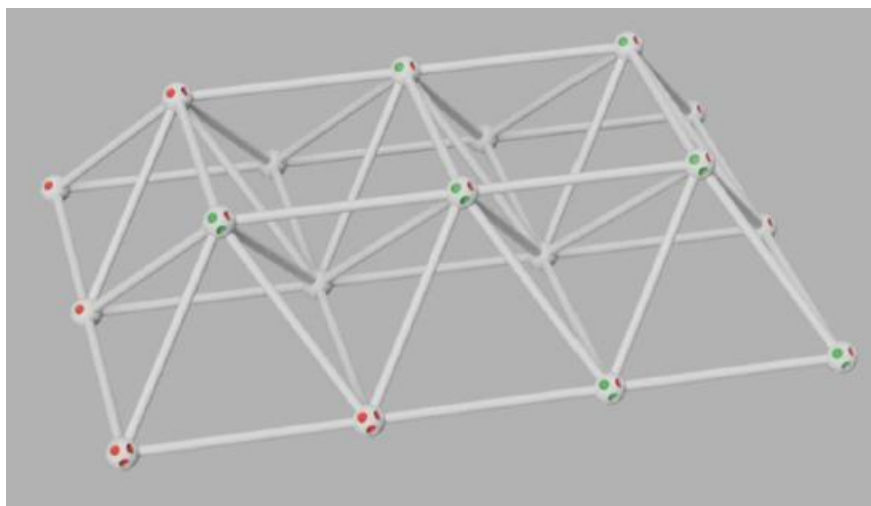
Стандартна ферма, виготовлена з 2-метрових бетонних труб [14]
